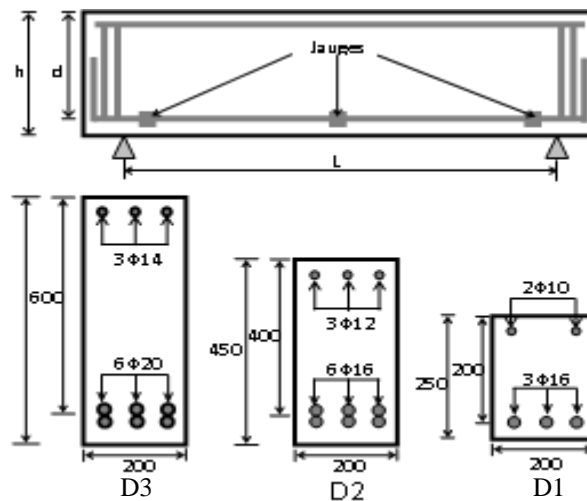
Détails de ferrailage des poutres testées (Dimensions en mm).
